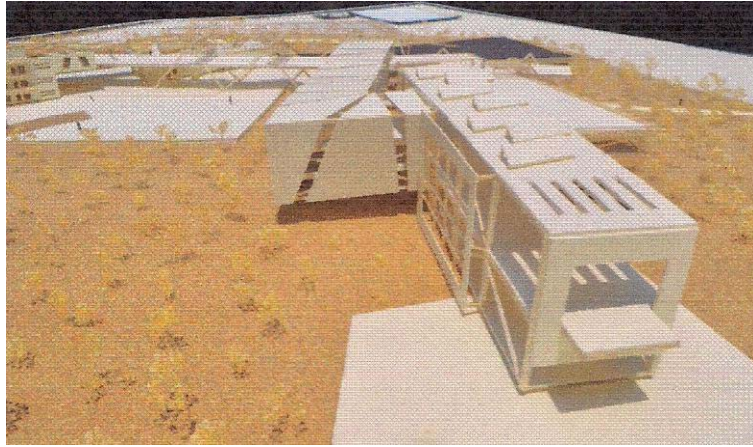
Vista de los paneles solares colocados sobre la cubierta del edificio C
